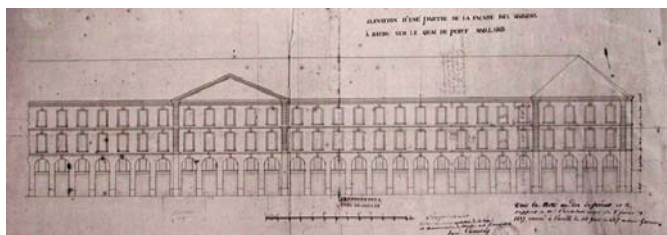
Façade d'un bâtiment du port Mallard établi par Ceineray en 1761 et extrait d'un module de façade
